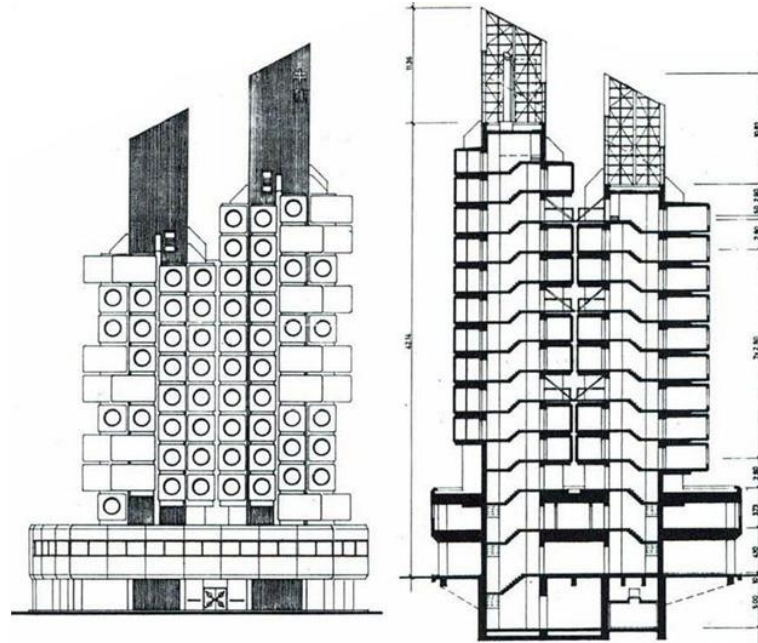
Головний фасад та розріз вежі [13]
